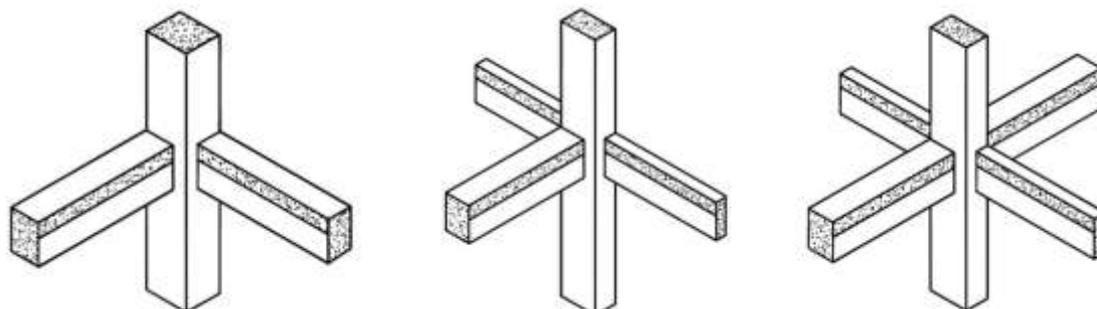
Tipos de pilares quanto à sua implantação em obra (pilar de canto, de borda e interno).
